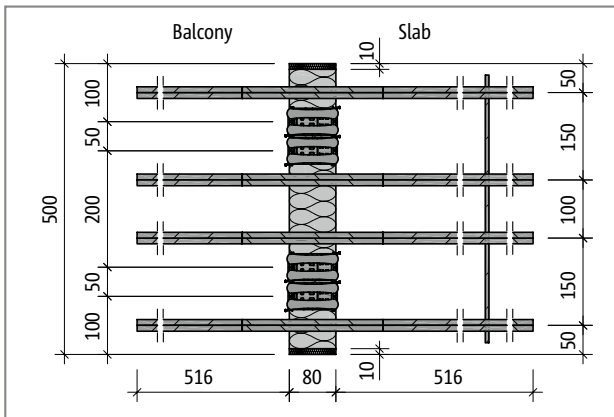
Schöck Isokorb® T type Q-E-VV5: Product layout; lateral fire protection boards
